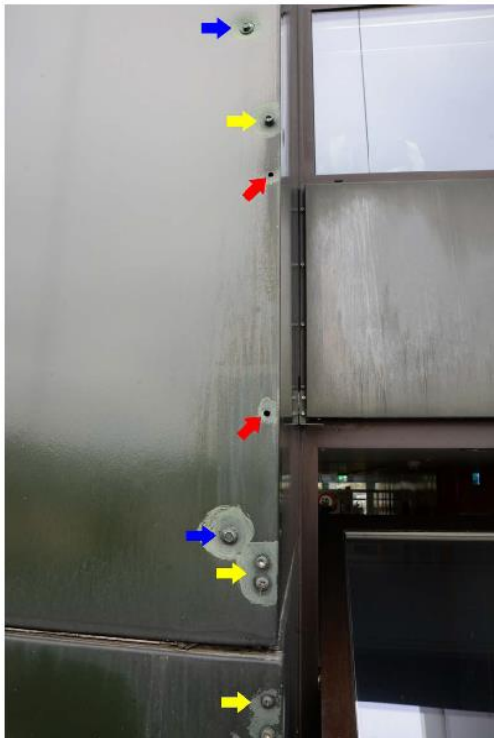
Position S10-05; fehlende Schrauben (rot), Dichtschrauben in Unterkonstruktion (blau), Schrauben zur zusätzlichen Eckverbindung (gelb)
